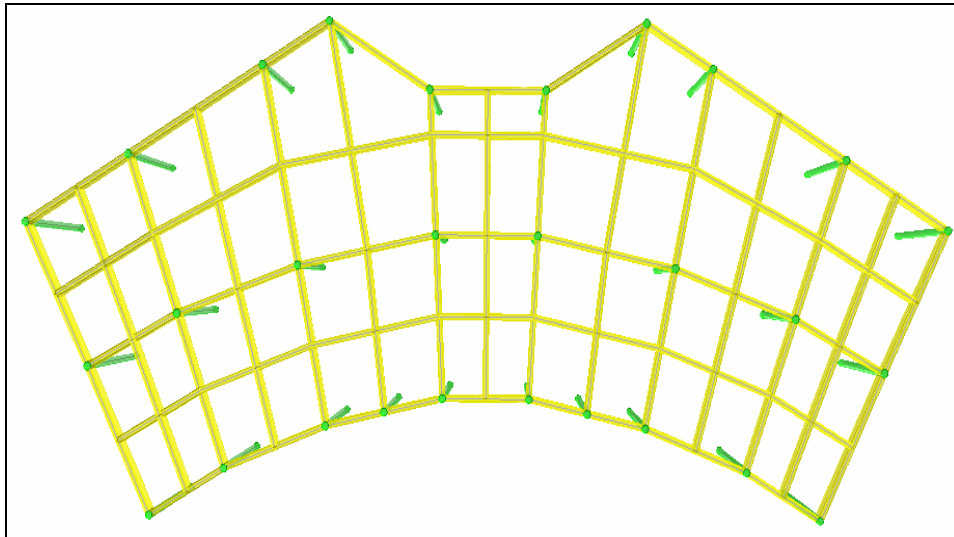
Distribución de vigas y columnas para la cubierta.
